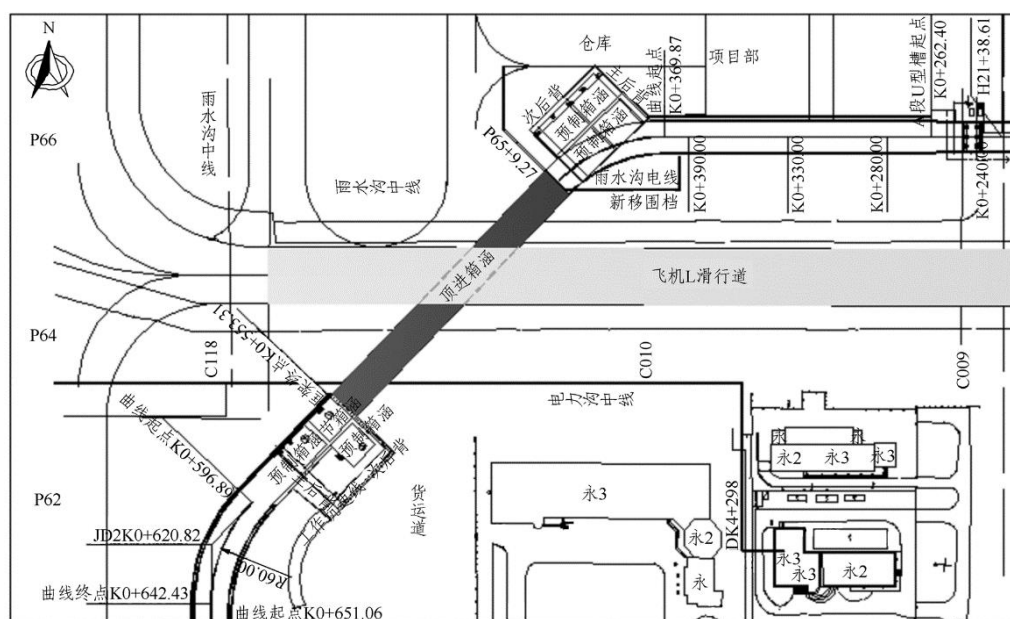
箱涵顶进穿越滑行道平面布置示意图
